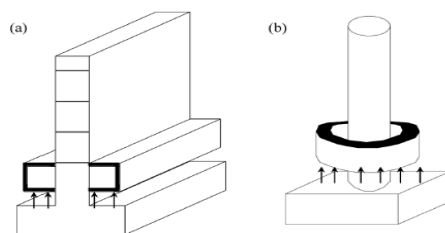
Instalação de sistemas em paredes com diferentes geometrias- a) Parede prismática b) Pilar cilíndrico [17]
